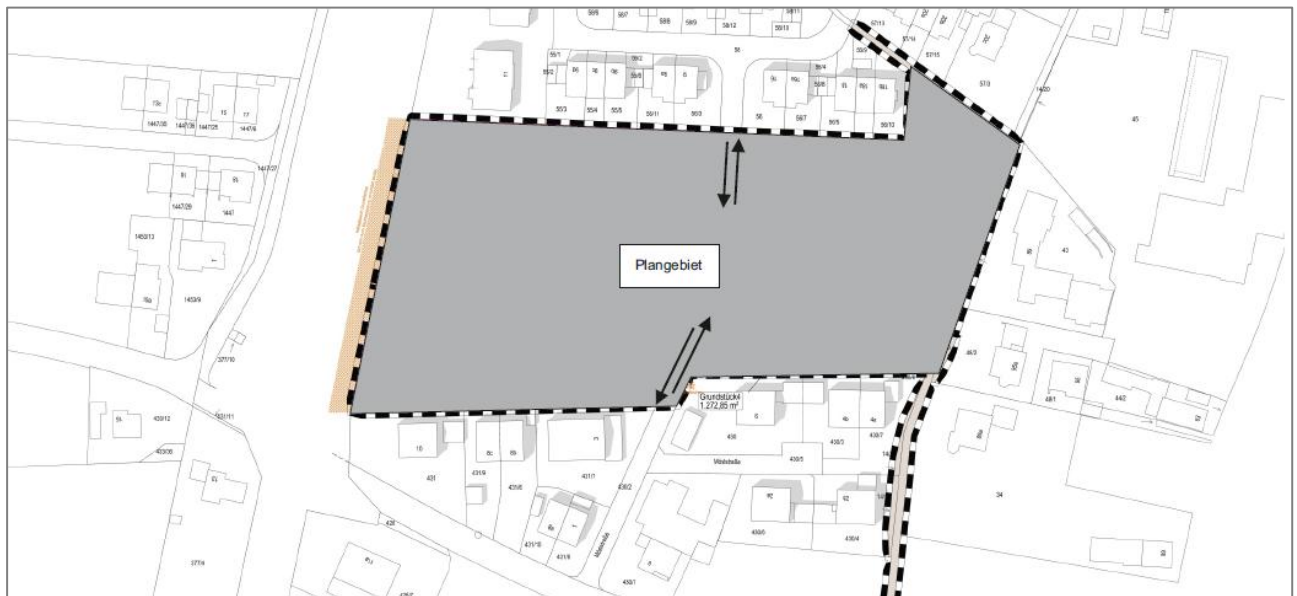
Erschließungsvariante I, Plangrundlage: Planungsgruppe Strasser
